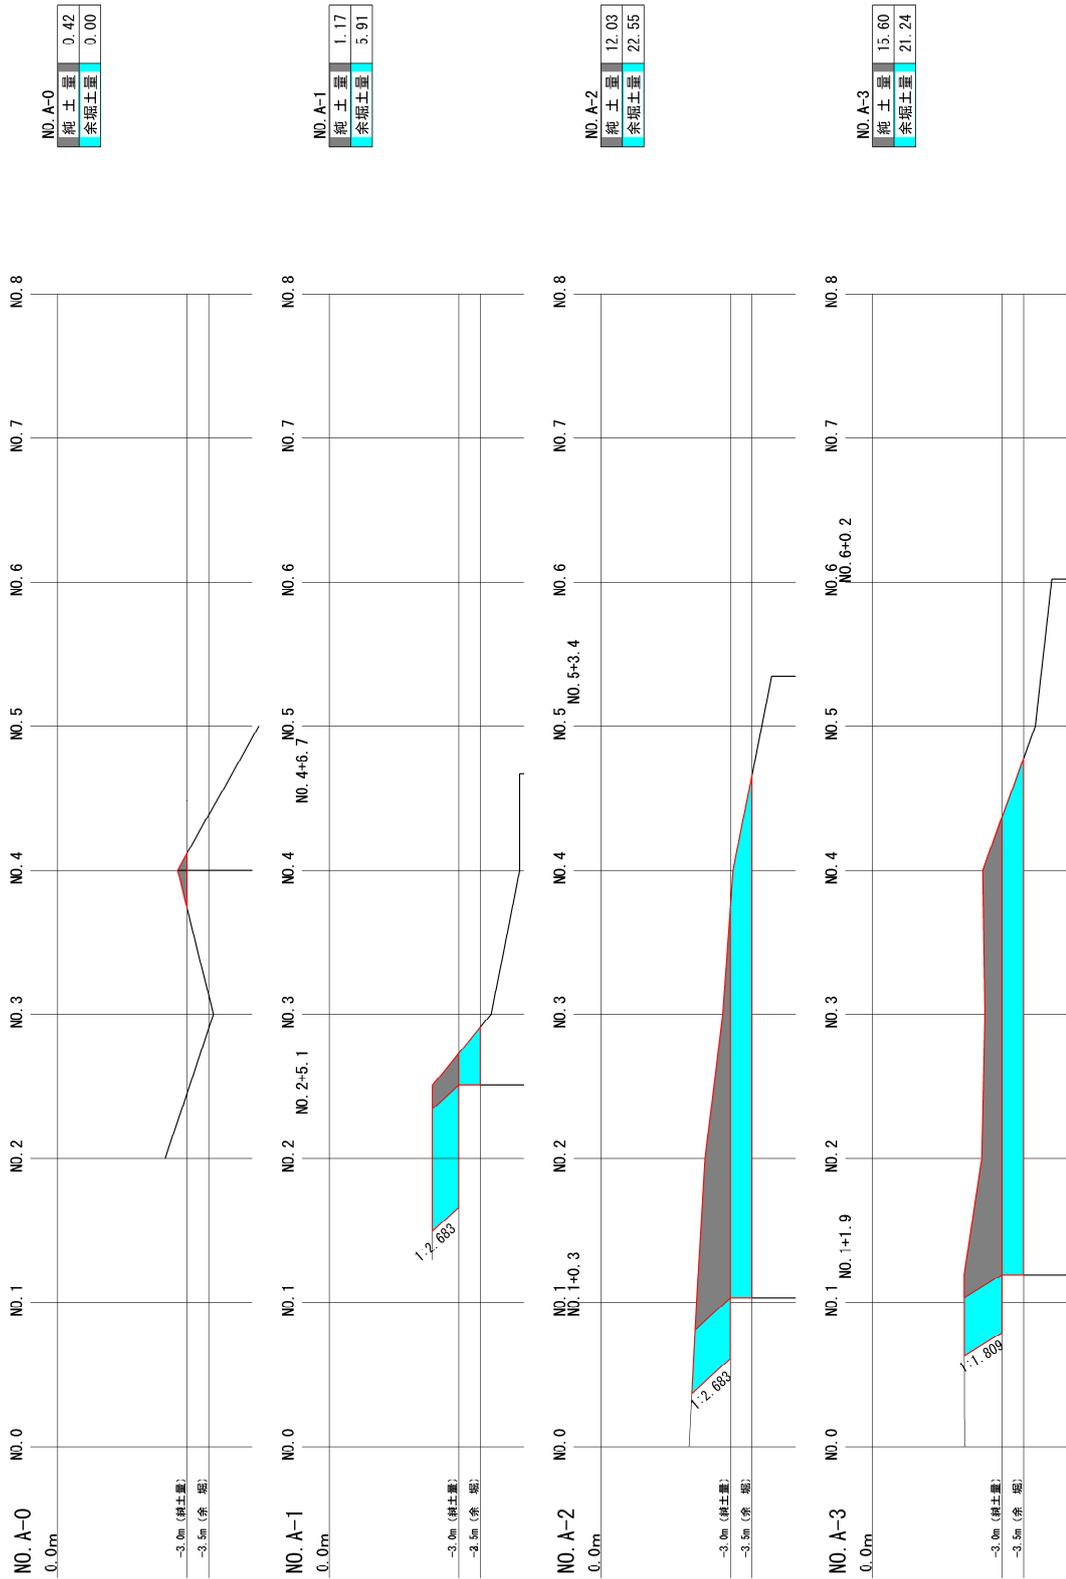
(1) 横断面 (A区) (測線 No. A-0~A-3)
